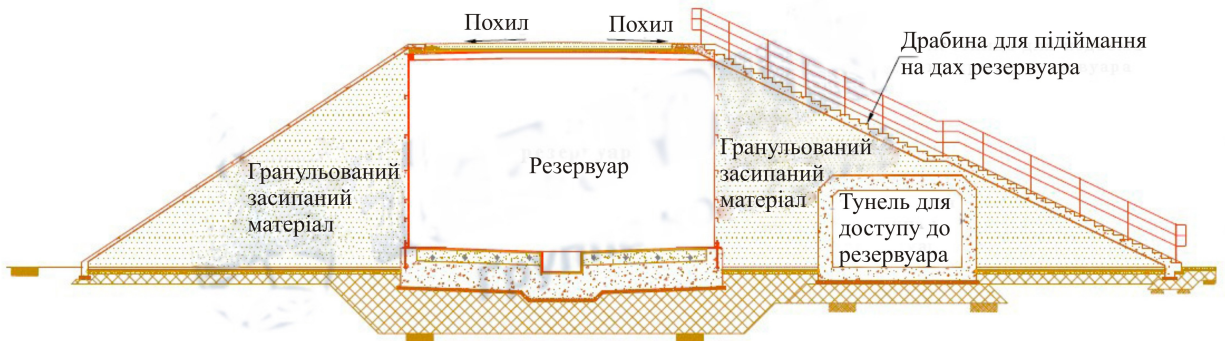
Вертикальний сталевий циліндричний резервуар для авіаційного палива з ґрунтовим насипом
